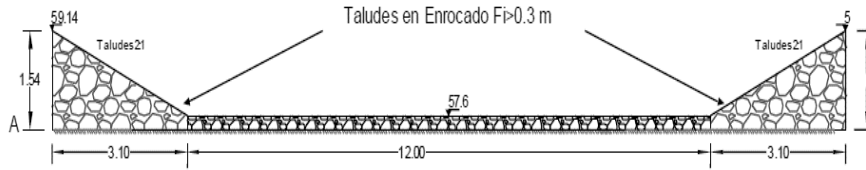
Sección transversal aguas arriba de la estructura de disipación de energía del Caño Piedras. Corte A-A.
